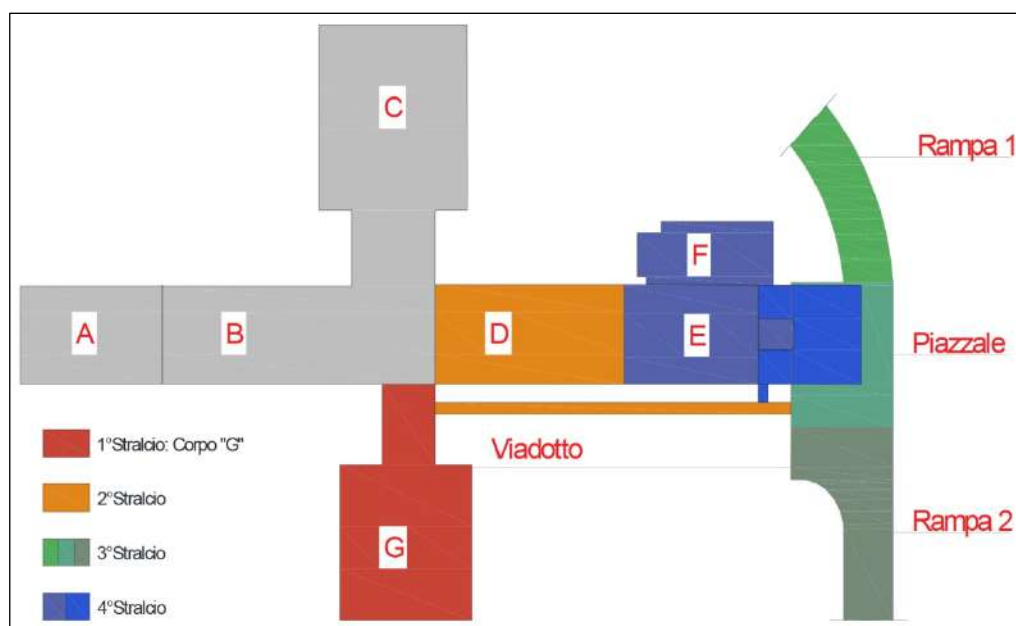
Schema planimetrico dell'ampliamento nel Padiglione A del Pronto Soccorso.
